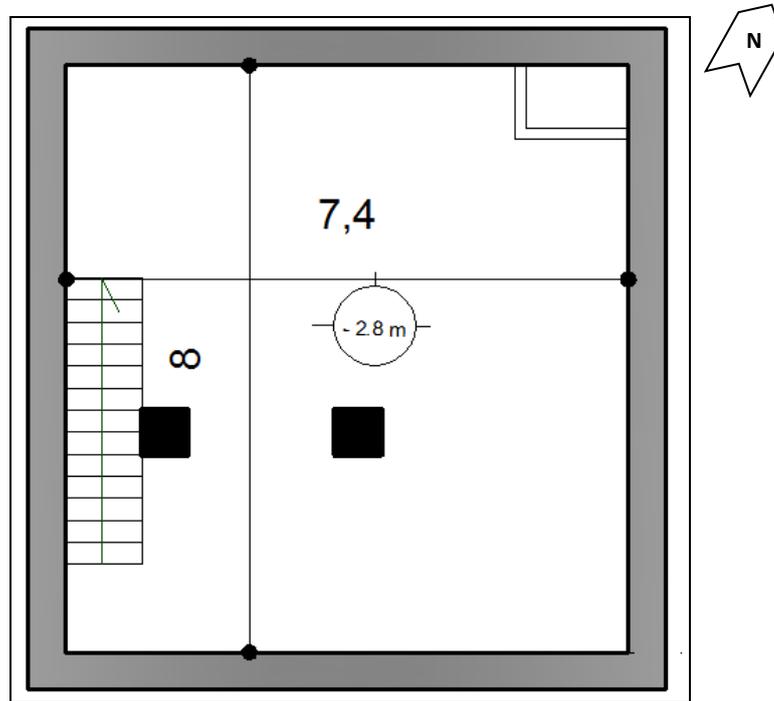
, plan du sous-sol, source : Ep Ech :1/100
